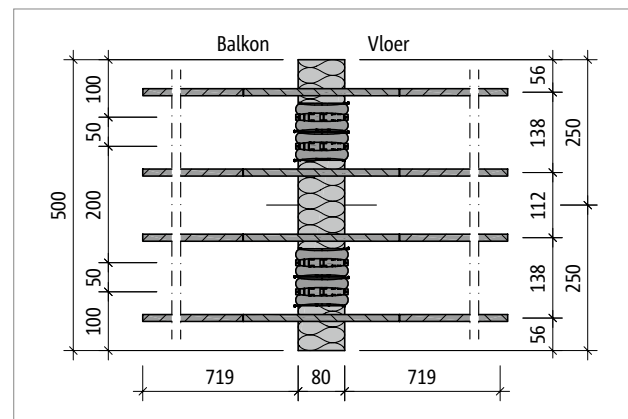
Schöck Isokorf® T type Q-E-V6: Doorsnede
